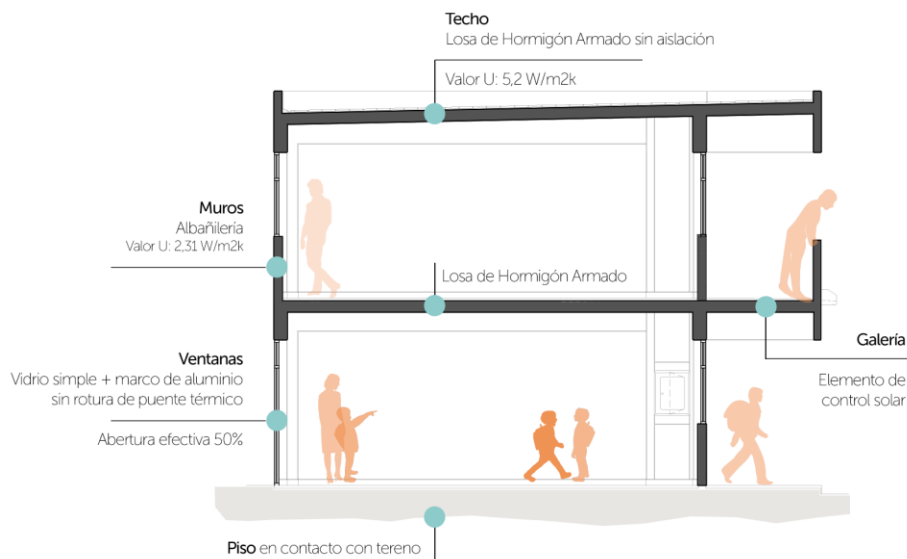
Corte tipo módulo A-B, elaboración equipo CEELA.
